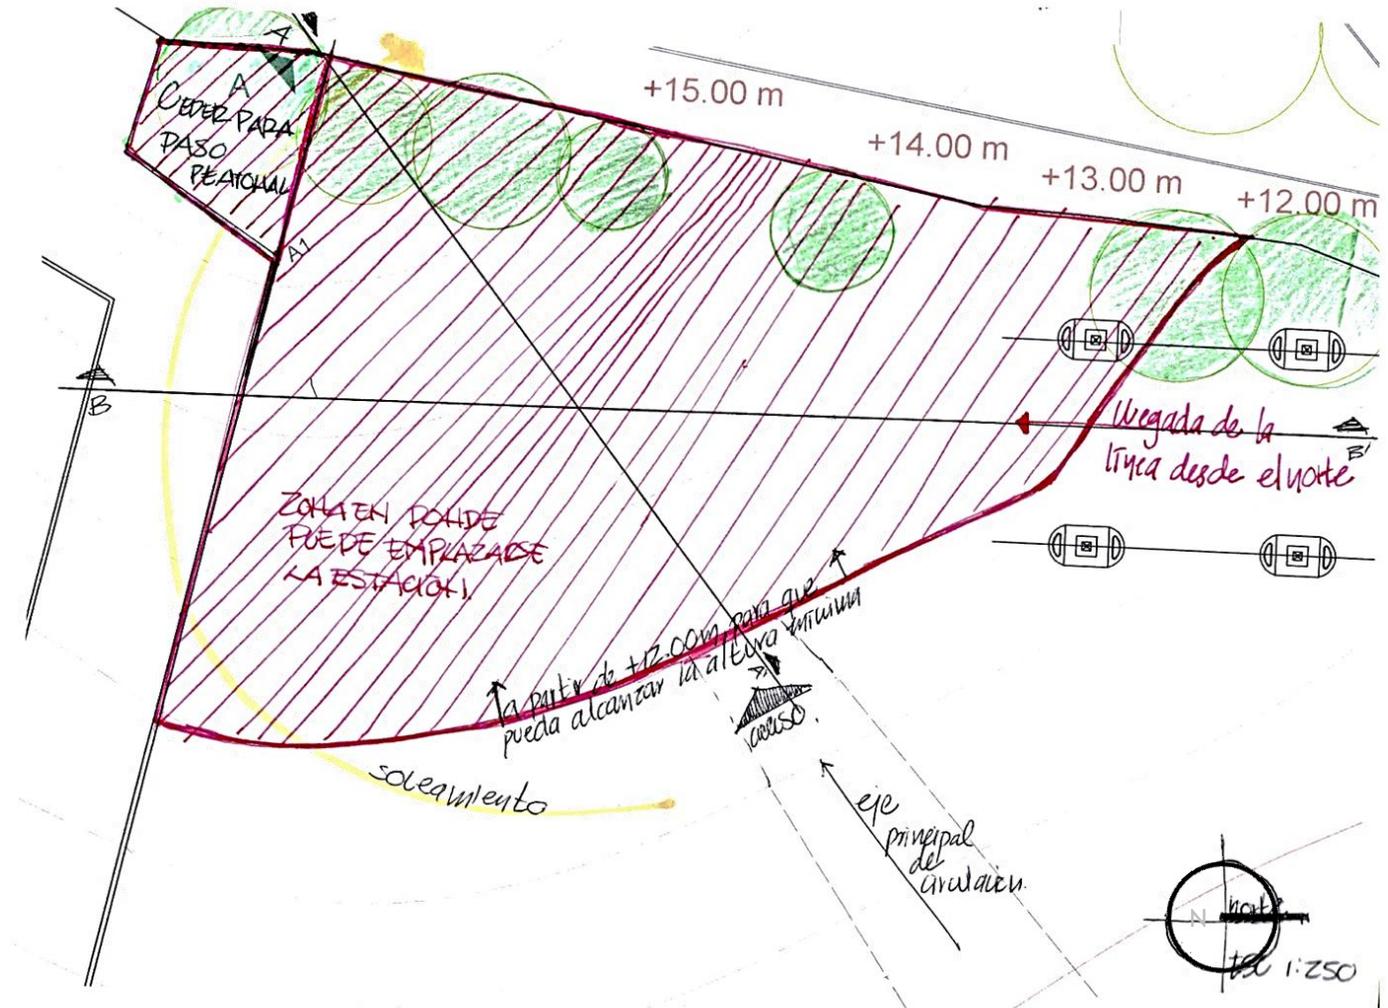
Terreno, sitio de emplazamiento para la estación
